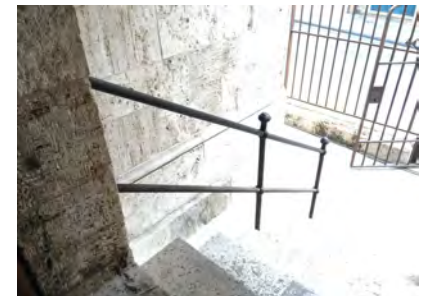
Detalle del pasamanos doble de la ESCALERA 1
